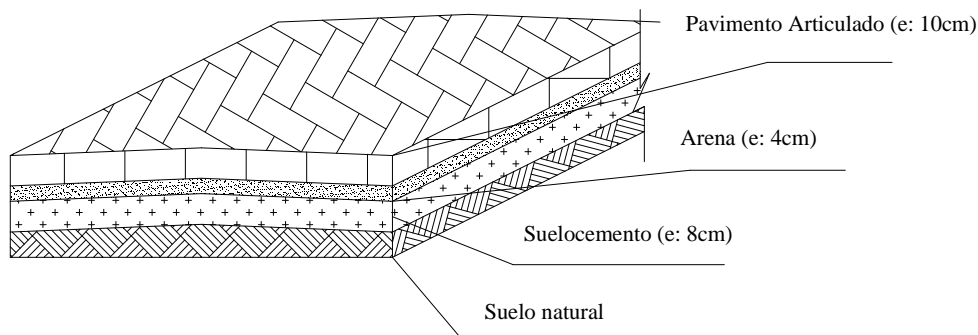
Distintos Espesores de las Capas del Pavimento
